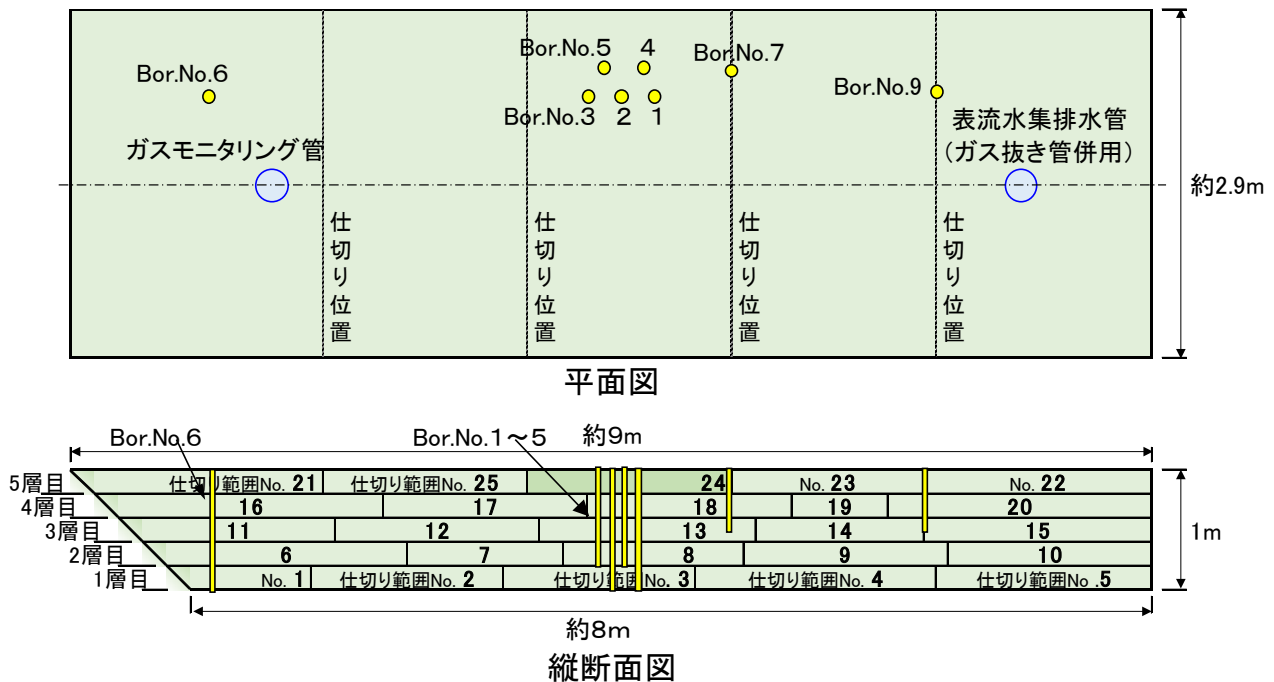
固化式埋立層の概要とコアボーリング位置（上：平面図，下：縦断面図）
